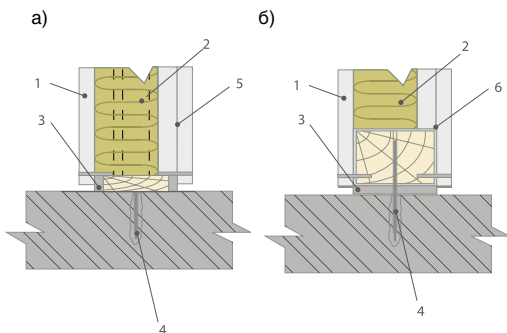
Опираие перегородок на междуэтажное перекрытие:
